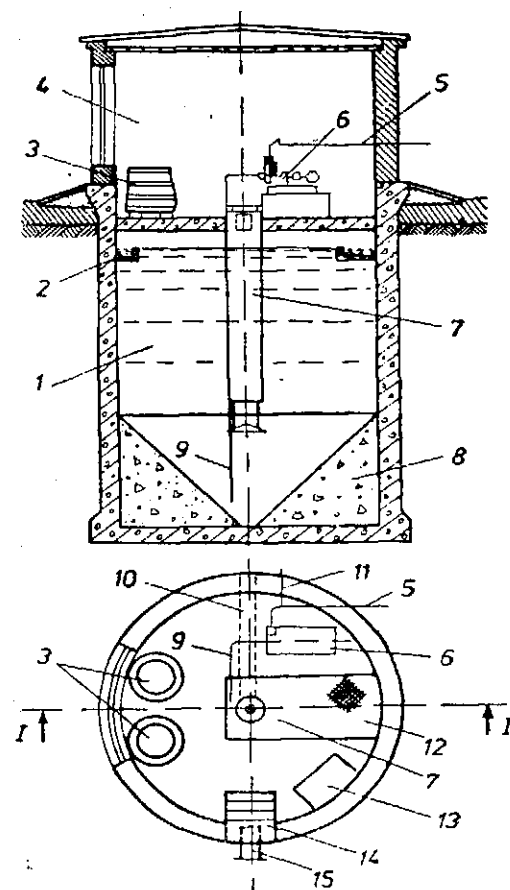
Schema constructivă a construcțiilor auxiliare bloc care deservesc șanțurile de oxidare:
